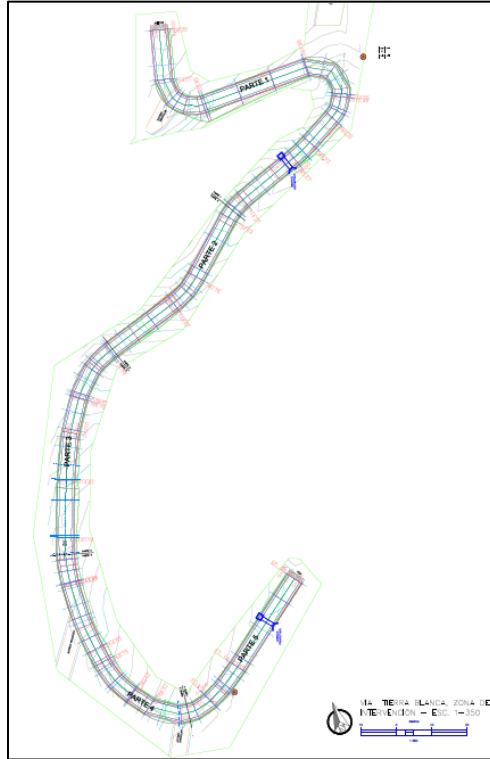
Imagen de planta del tramo 3 del proyecto de Málaga-Santander
